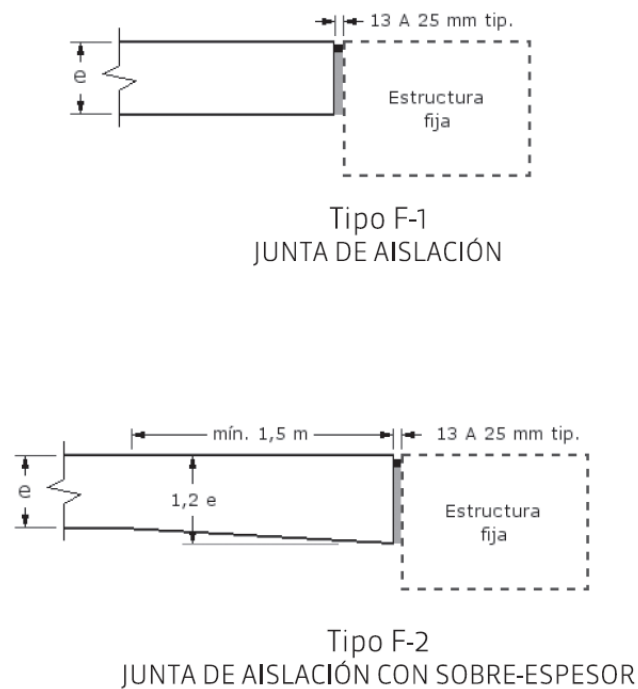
Tipos de juntas de aislación. (Fuente: ICPA)
